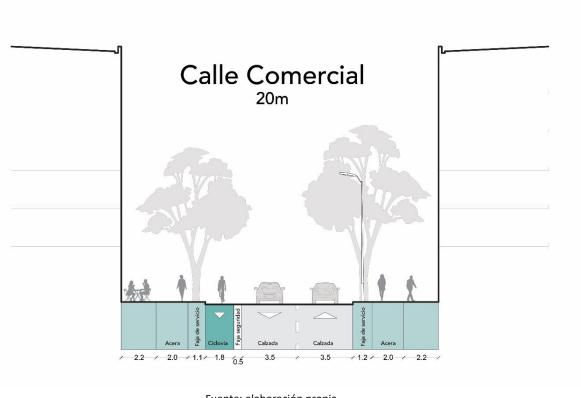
Guía de diseño para Ejes comerciales (Perfil vial: 20 m)
